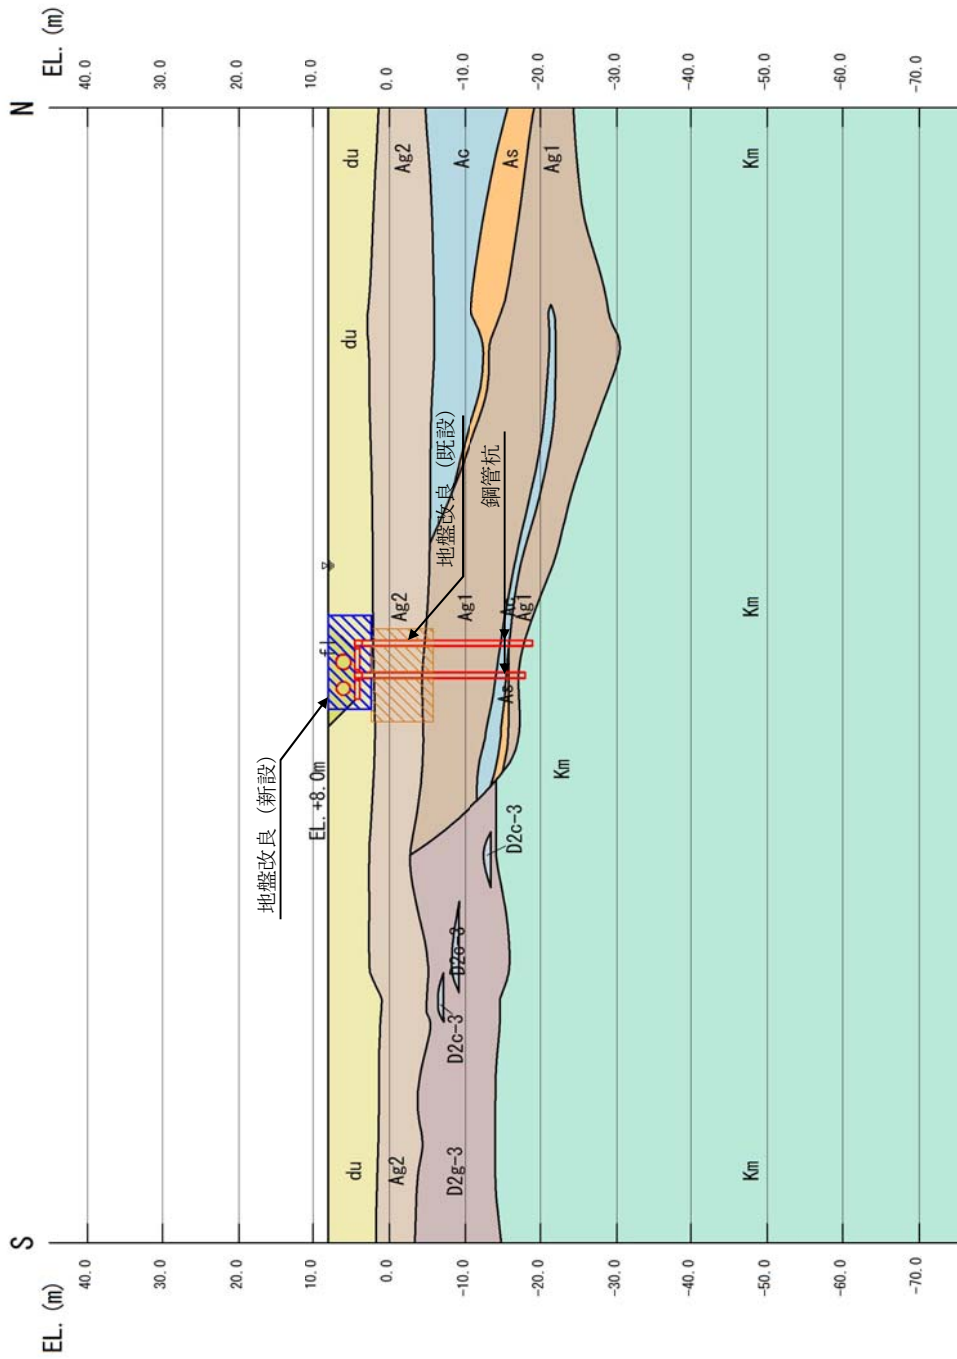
(3) 屋外二重管の横断面図 (C-C断面・杭基礎部) (区間Ⅱ 候補断面⑥-I)
